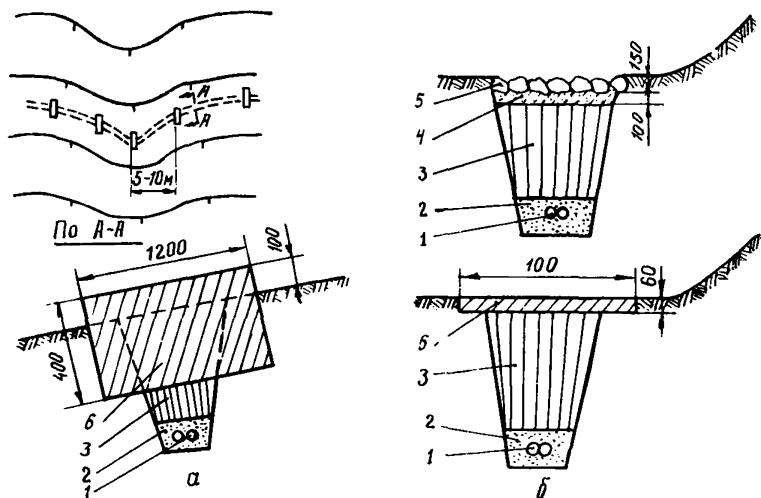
Защита траншеи от размывания на поперечном уклоне: а - при уклоне $5-15^{\circ}$; б - на спланированной полке; 1 - кабель; 2 - мягкий грунт; 3 - местный грунт; 4 - песчано-цементное основание; 5 - булыжник; 6 - железобетонная плита
